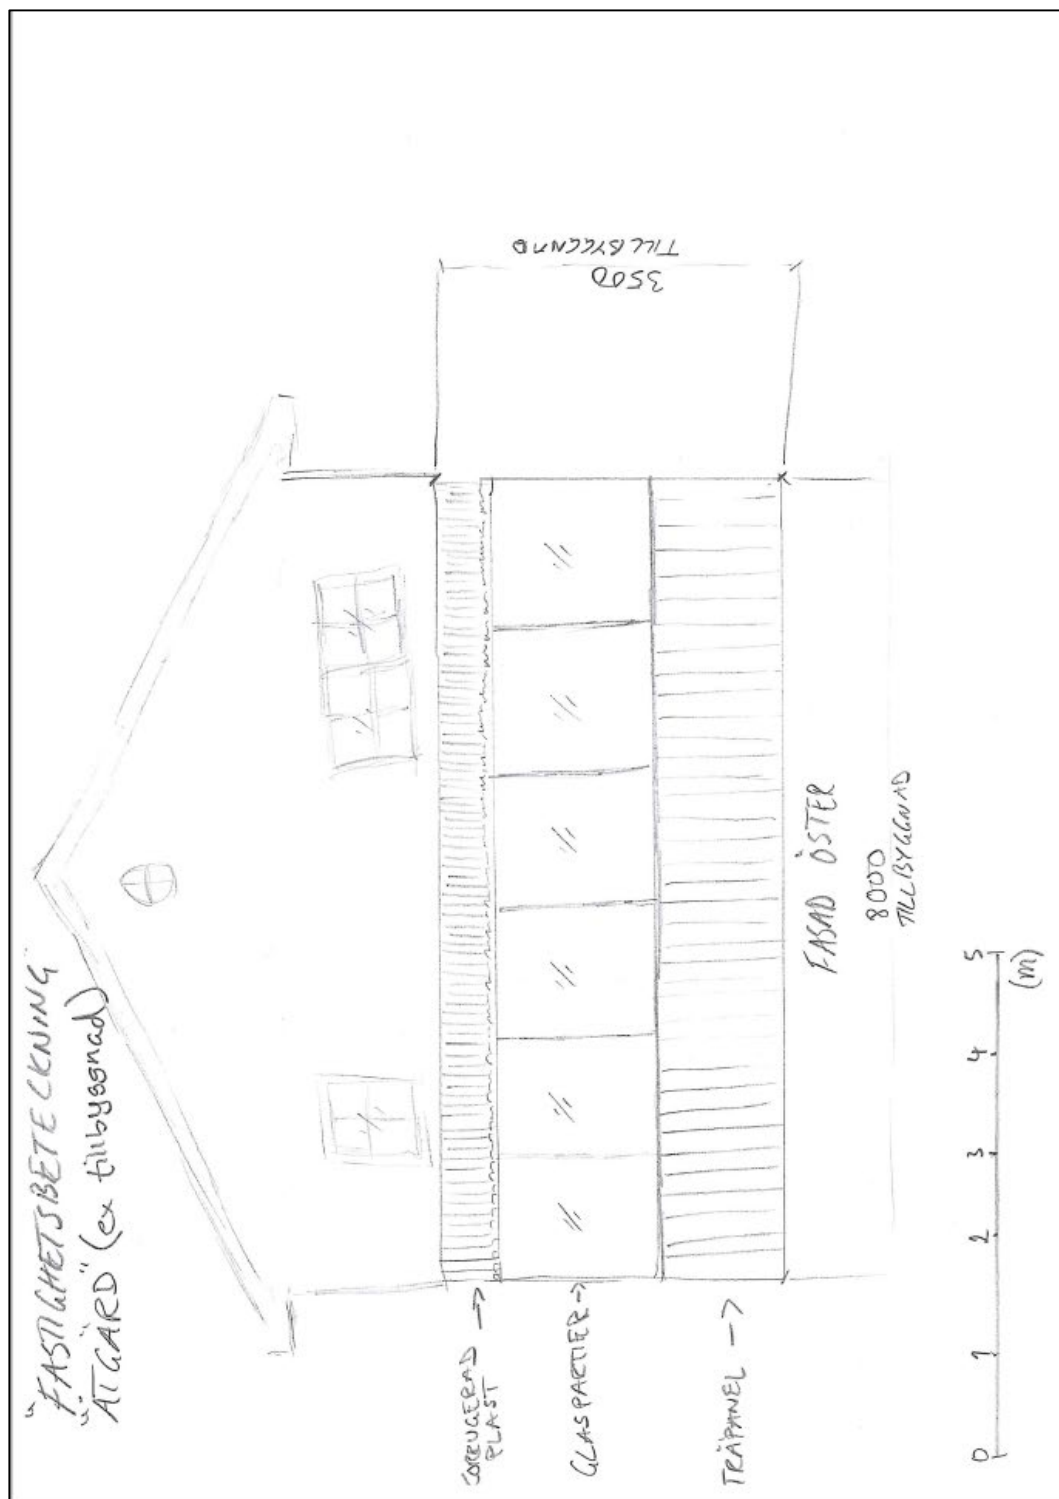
Exempelritning. Enklare skiss som stöd för handläggare att bedöma om byggnationen kan uppföras utan bygglov och anmälan.
